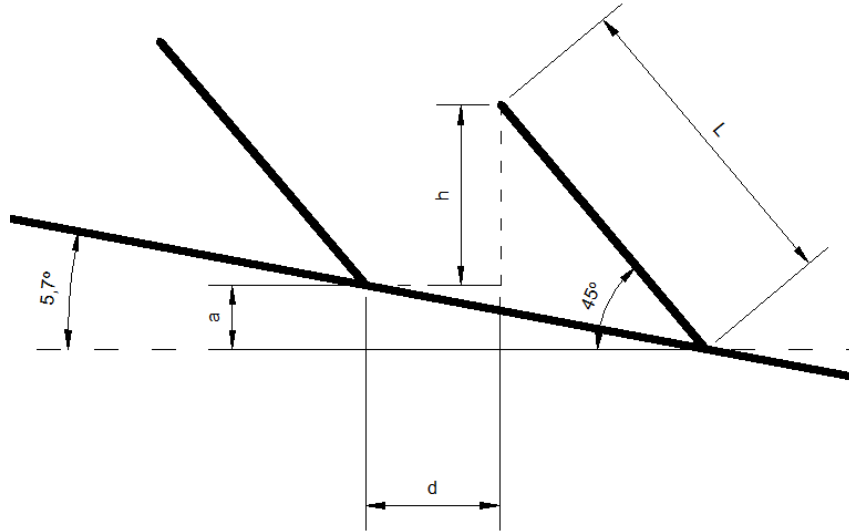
Esquema para el cálculo de la separación entre placas zona 1 y 3
